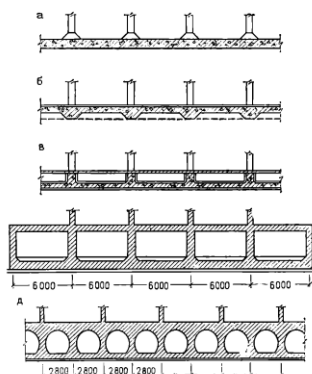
Сплошные фундаментные плиты:а-без ребер;б-ребрами вниз; ребрами вверх; г-коробчатые; д-объемный фундамент
